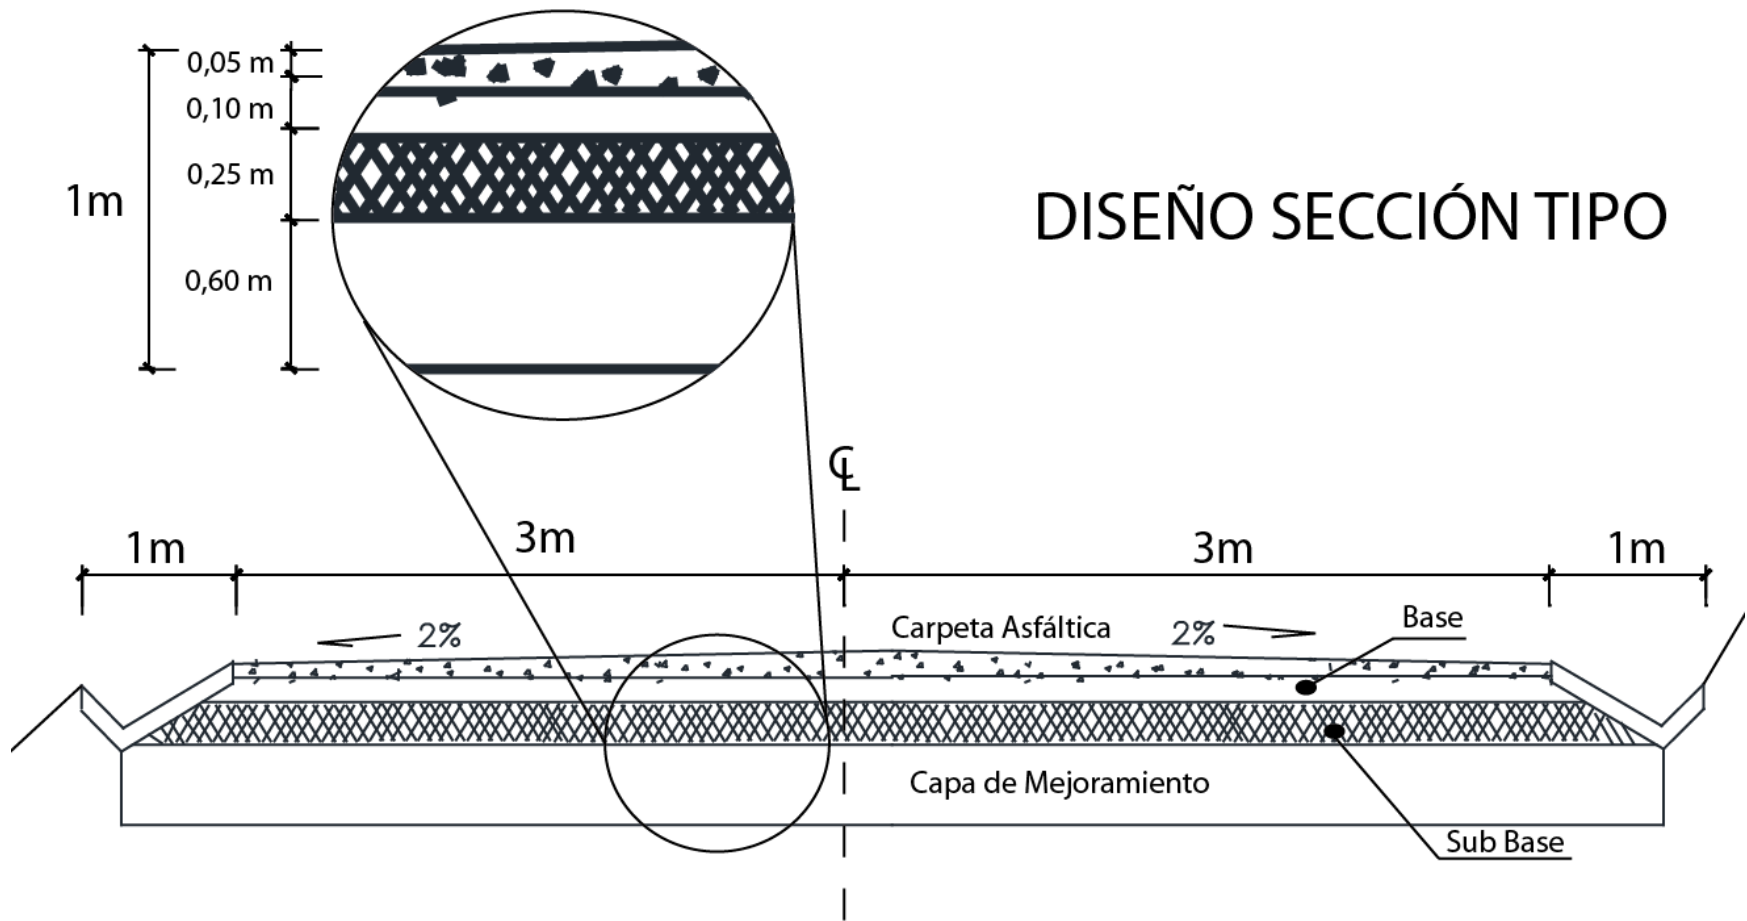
Gráfico del diseño de la estructura del pavimento
